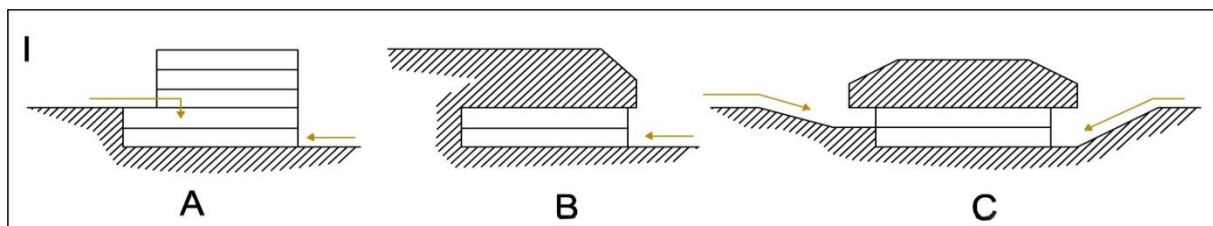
Ouvrages partiellement souterrains accessibles de plein pied
